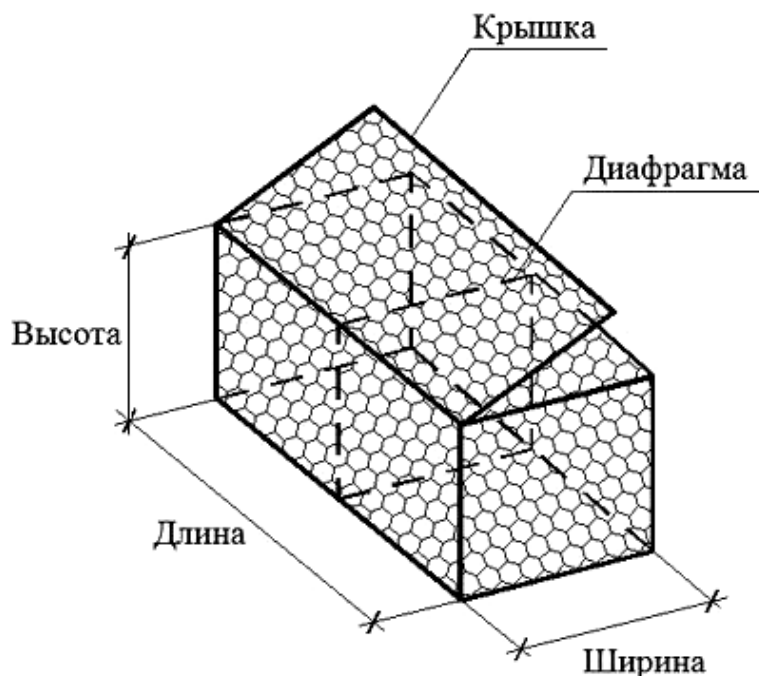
Конструктивная схема габионных конструкций коробчатой формы
